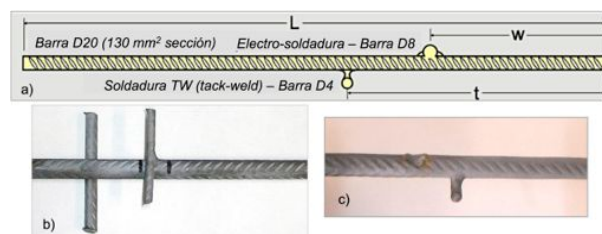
a) Configuración de las probetas para el ensayo de fatiga; b) Vista general de las probetas antes de ensayo; c) Probeta singular, con entalla semicilíndrica producida por el desprendimiento del alambre D8 de la soldadura EW, al extraer la probeta de la viga
